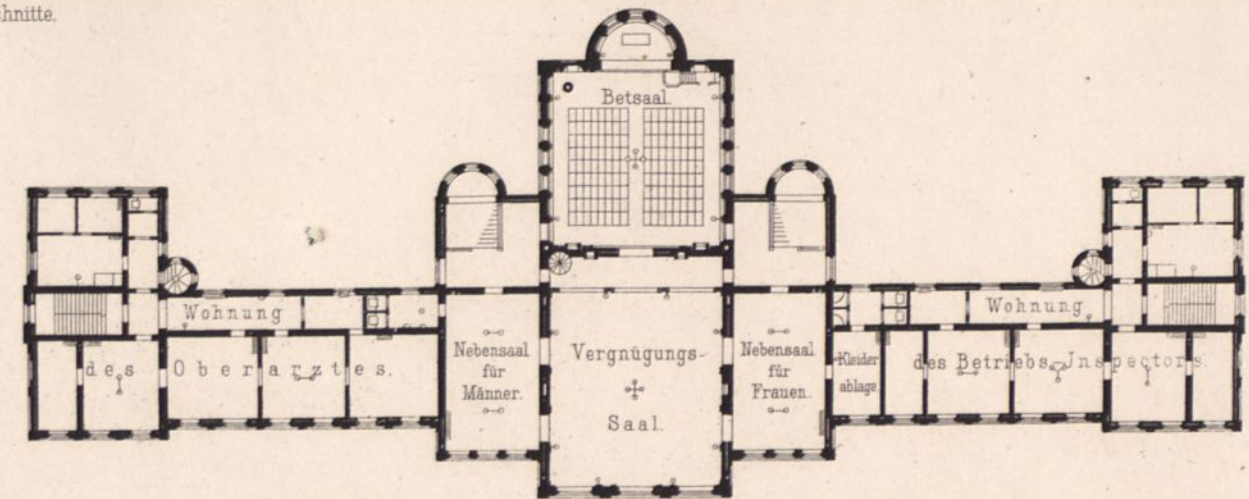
Verwaltungs-Gebäude. Grundriss des Obergeschosses.
